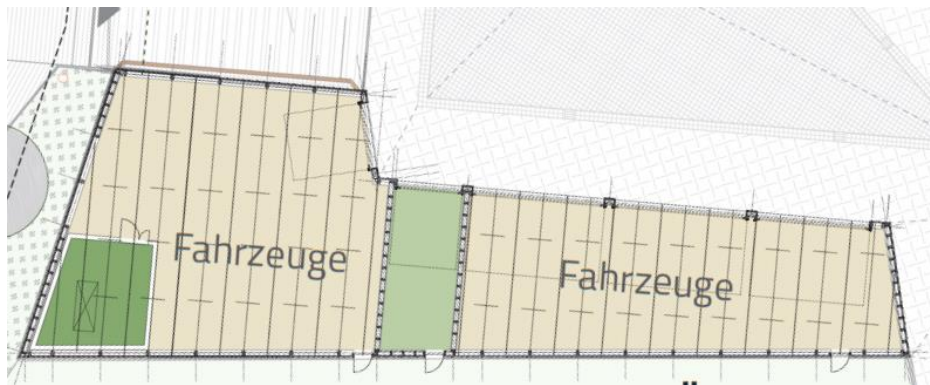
Grundriss Fahrzeughalle
